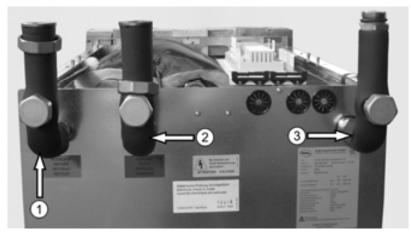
Rohre Rücklauf ① und Vorlauf ② sowie Rohr Kesselsicherheitsgruppe ③ der Verpackung entnehmen und an den Kessel anschrauben. Dichtung aus Beipack verwenden.
